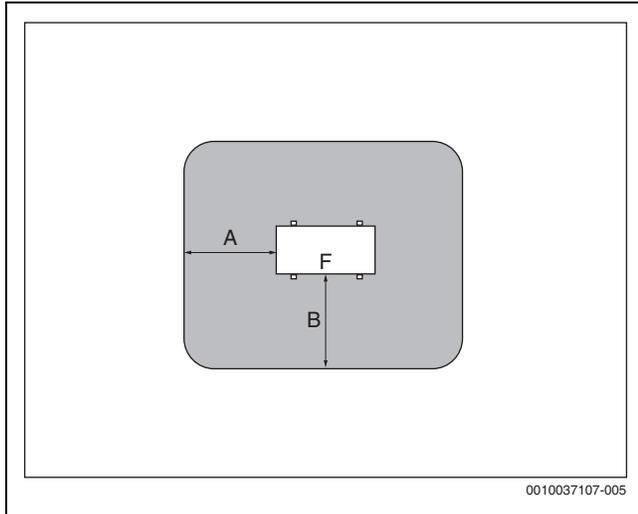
Zona di sicurezza per installazione a basamento sul terreno di pertinenza o sul tetto
